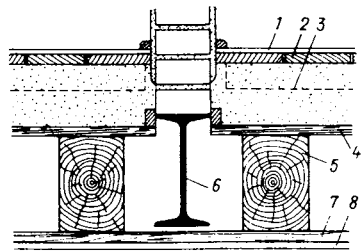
Крепление перегородки стальной несущей балки к деревянному перекрытию со средней степенью воспламеняемости
